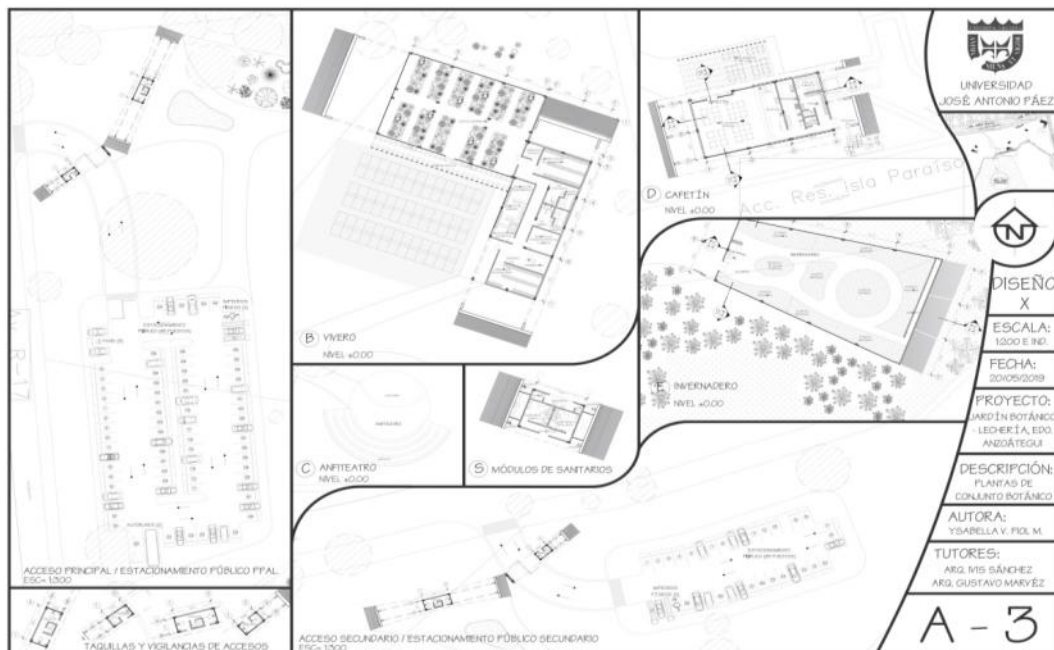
Plano A-3: Planta de las otras Edificaciones. Fuente: Propia
